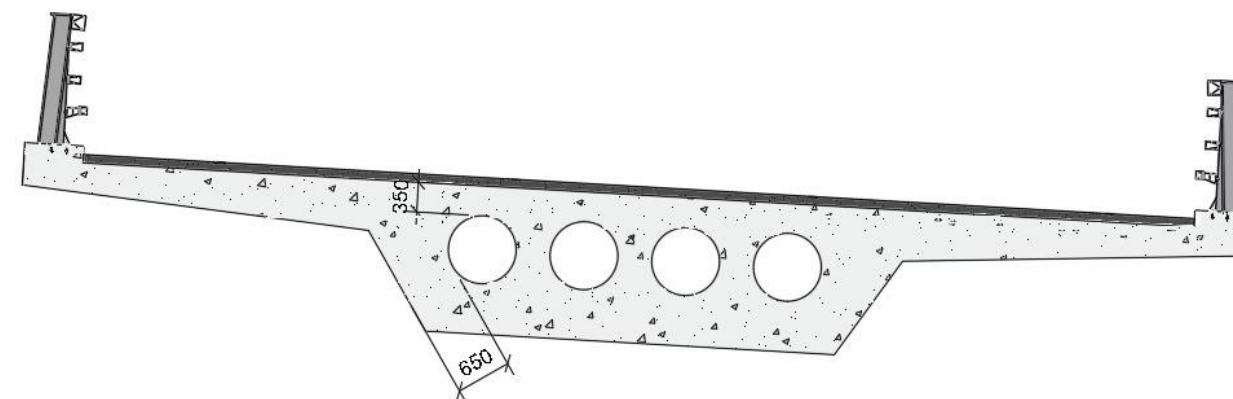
Detalle de los aligeramientos de polietileno expandido en una sección tipo.
